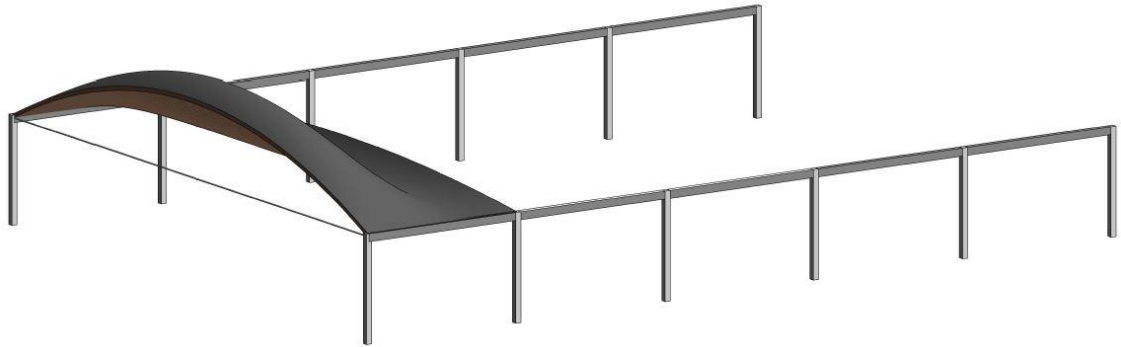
Proceso constructivo Fase 8 Fuente: Elaboración propia
